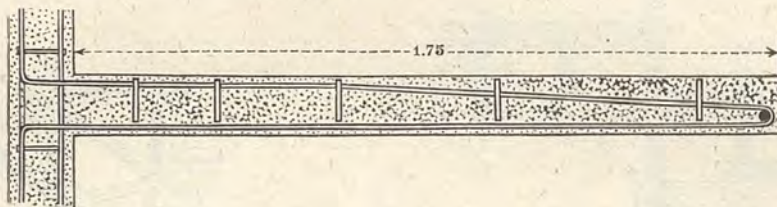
Sezione trasversale di una soletta per rampa a sbalzo in cemento armato incastrata in muro pure di cemento armato.
